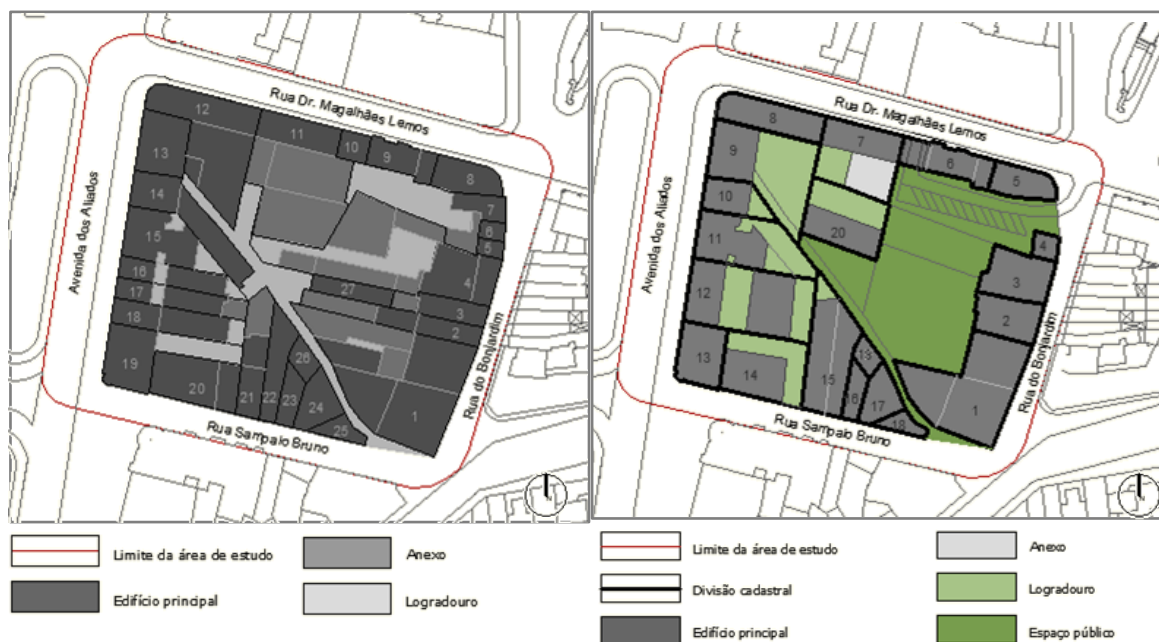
Planta síntese do quarteirão existente e planta da proposta com numeração das parcelas.
